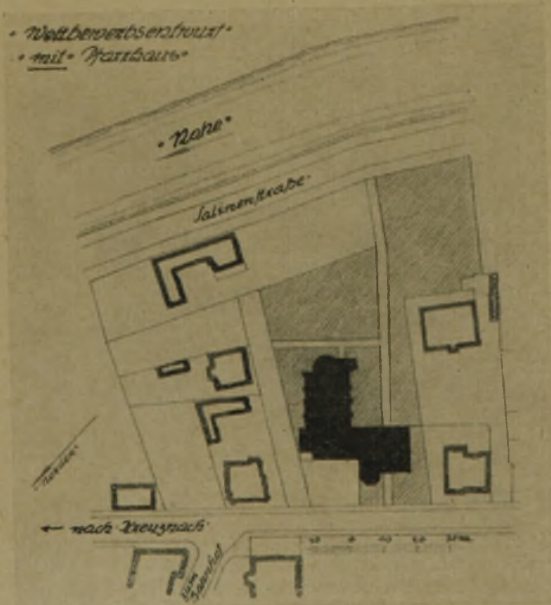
Lageplan des Wettbewerbs-Entwurfes.
